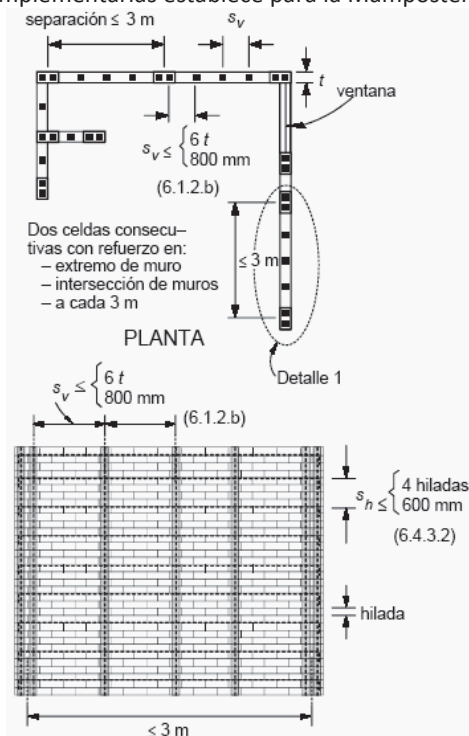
REQUISITOS PARA MAMPOSTERÍA CON REFUERZO INTERIOR
